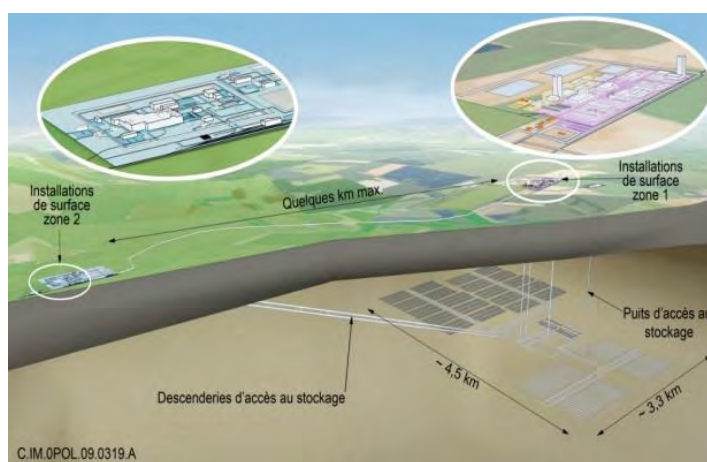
Schéma du site de construction de l'ouvrage de stockage
